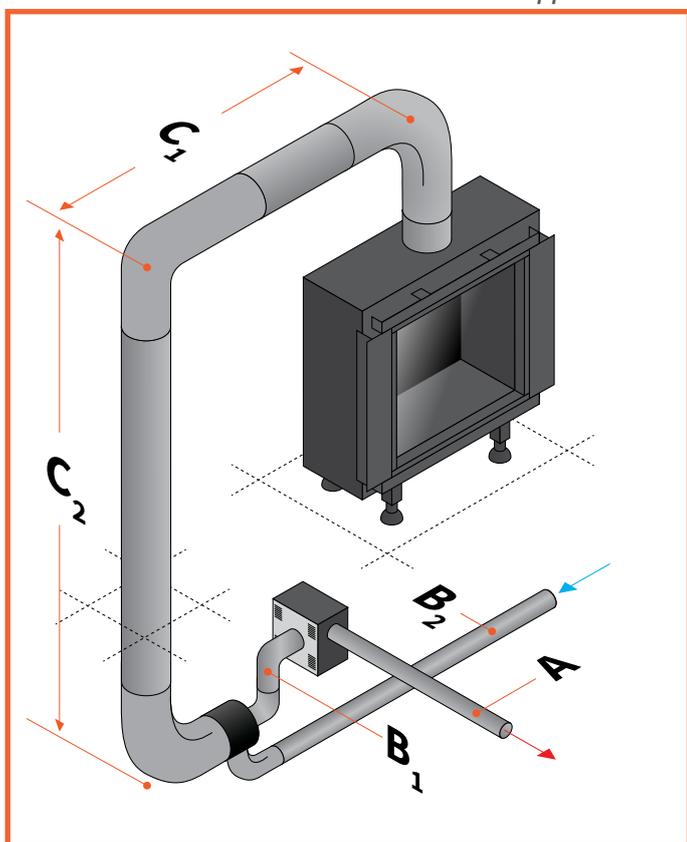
Exemple d'installation de conduit vertical négatif
